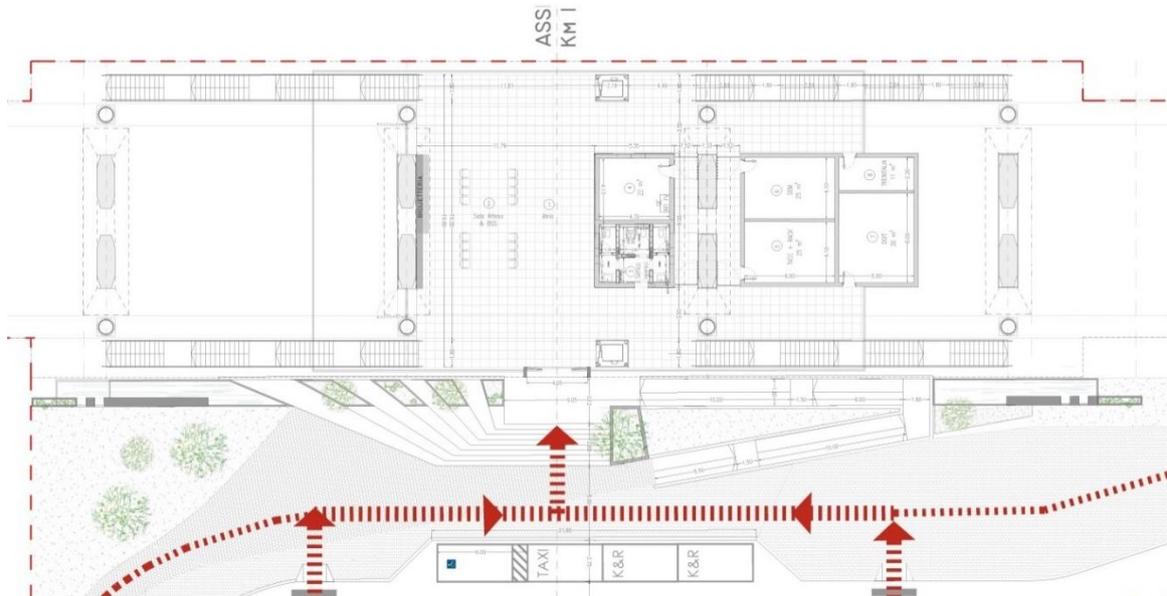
Pianta piano terra e accesso dal piazzale antistante
